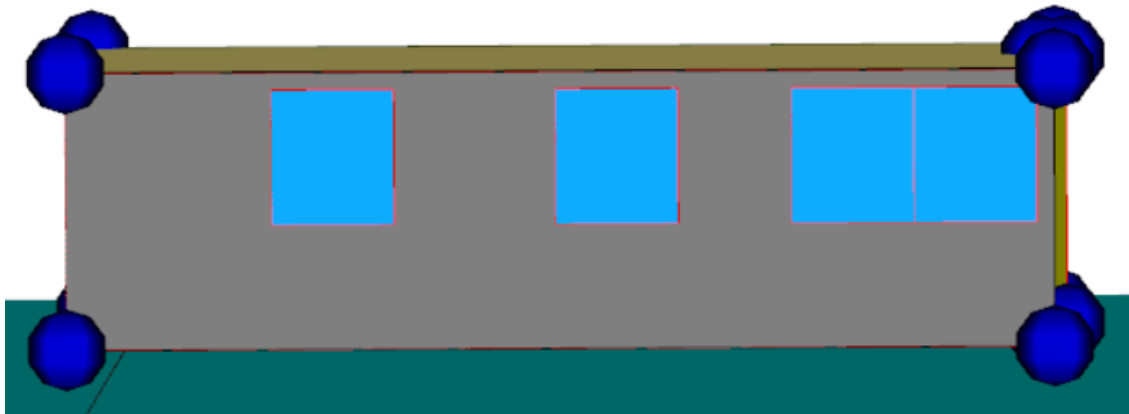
Vista en Lider Hulc Calener de Fachada Trasera Orientación Sur.
